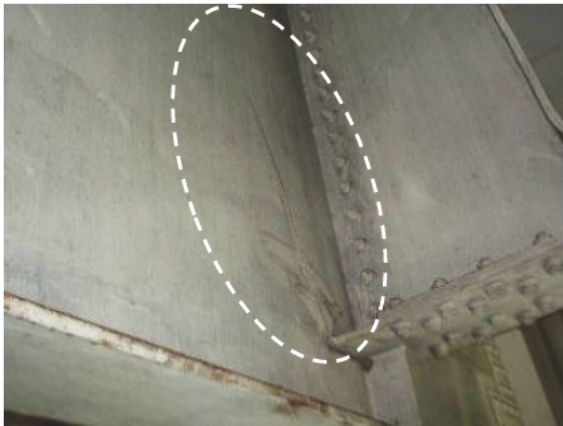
山添橋の主桁 - 横桁溶接部のき裂
